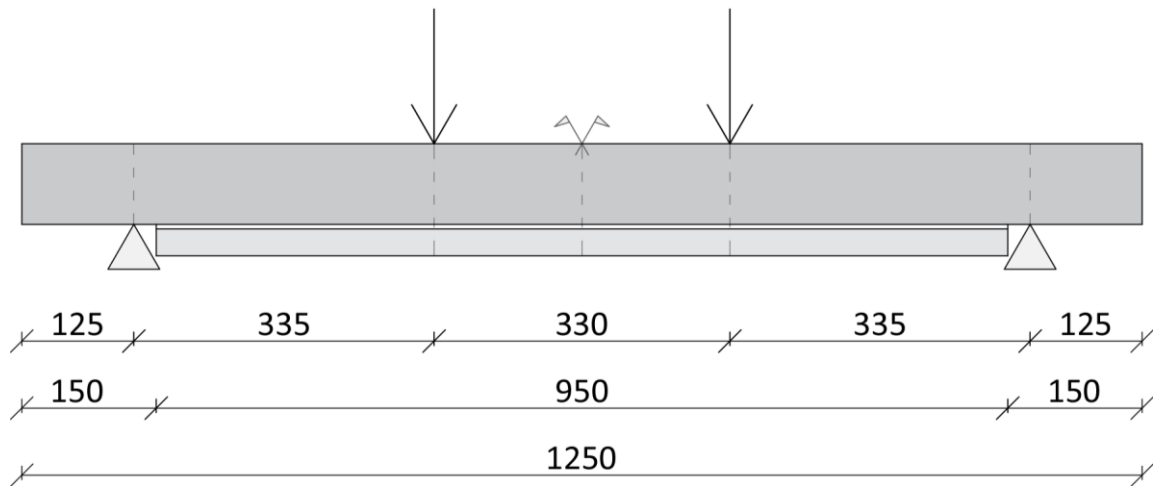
Geometría de la viga reforzada, posición de las cargas y los apoyos.
